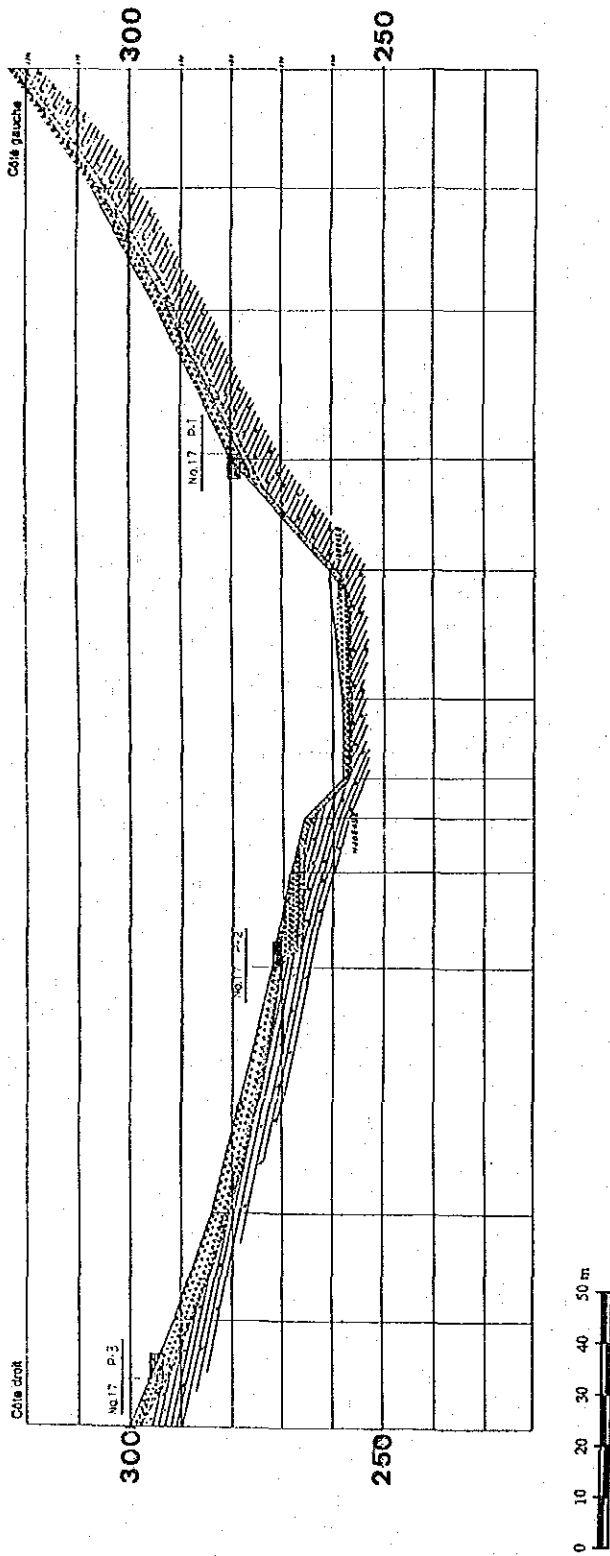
Coupe géologique du site du barrage No. 17
